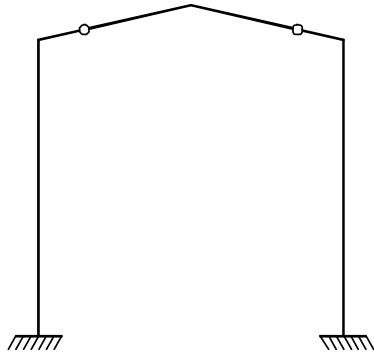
Elementos verticais engastados na fundação e duas articulações na trave (apud EL DEBS, 1996).
